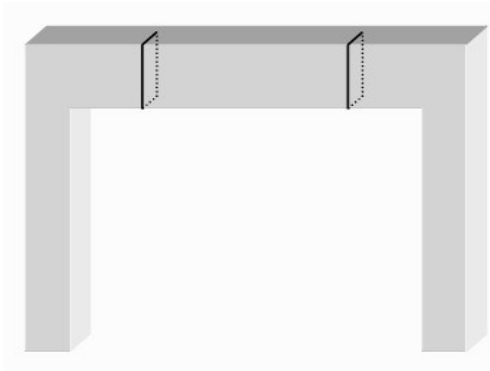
Esquema de viga com fissuração devido a variações térmicas (Araújo,2003).
